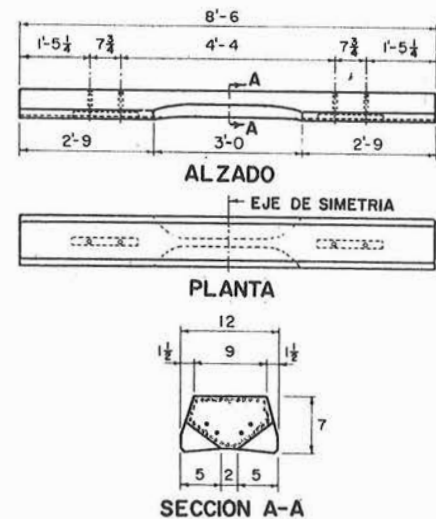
Traviesa de hormigón pretensado. Proyecto E de la AAR.
